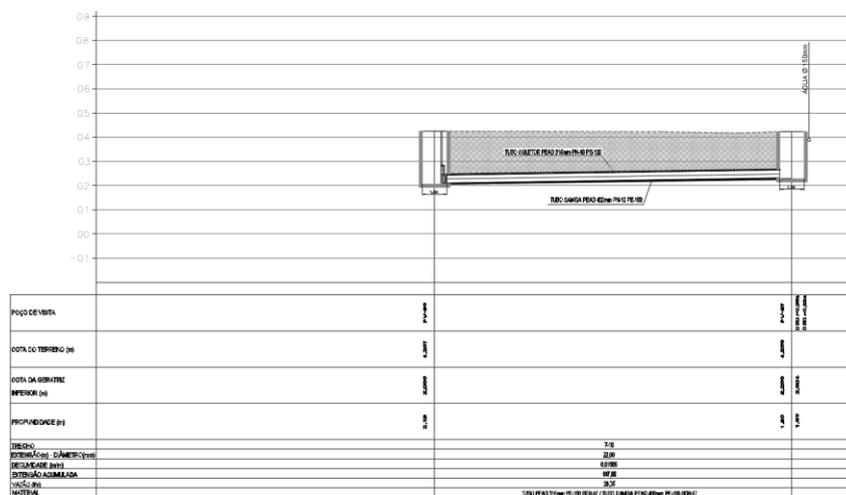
Perfil longitudinal da travessia SB-T20 - PV-97 AO PV-98
